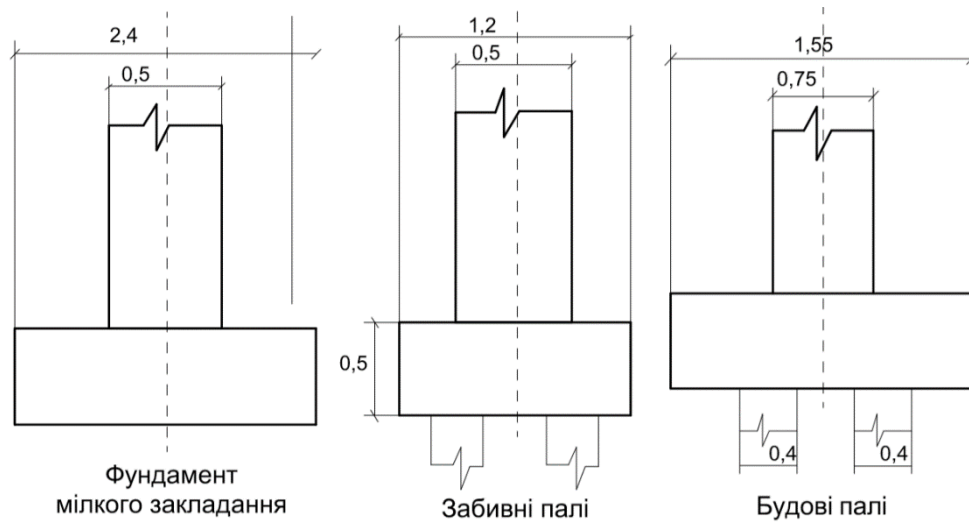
Конструктивні рішення варіантів фундаментів і поперечний переріз котловану
